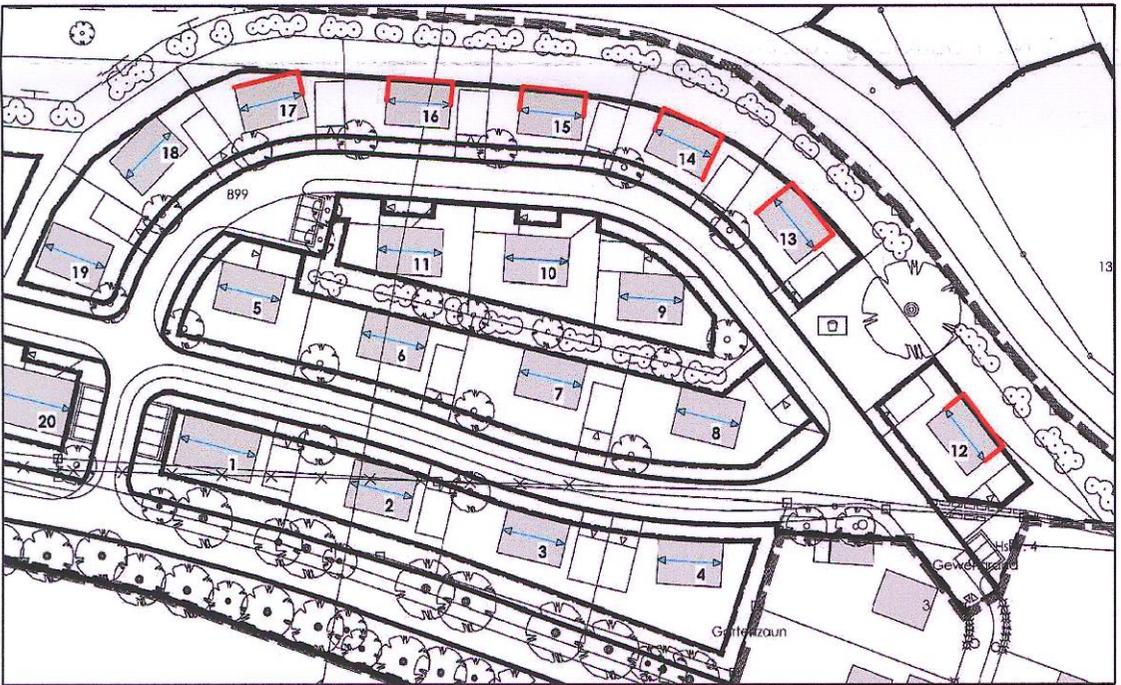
Lageplan mit Kennzeichnung der Fassaden, an denen Schallschutzmaßnahmen an schutzbedürftigen Außenwohnbereichen erforderlich sind (Maßstab 1:1.500).
